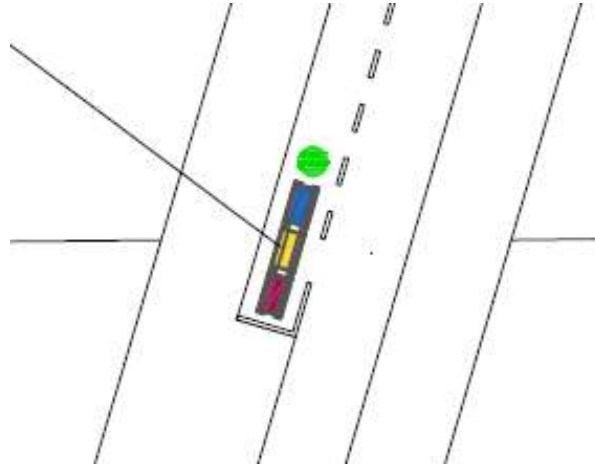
Situación de los contenedores en planta. Fuente: Autocad.
